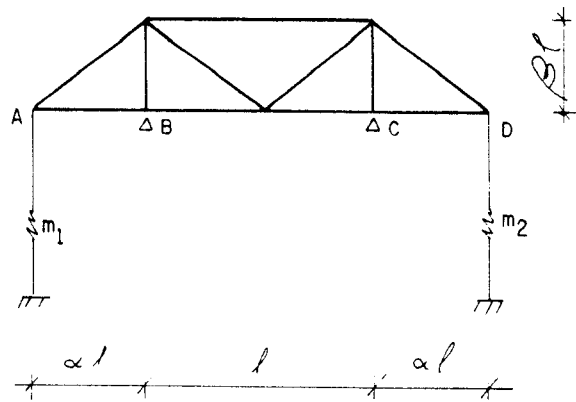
SISTEMA ESTRUTURAL SIMPLIFICADO
